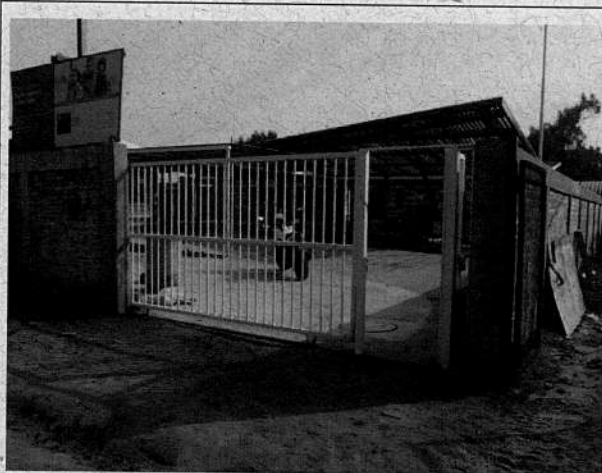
, 9-08-16: Pintura intumescente estructura metálica, Loma Linda, Villa Alemana.
